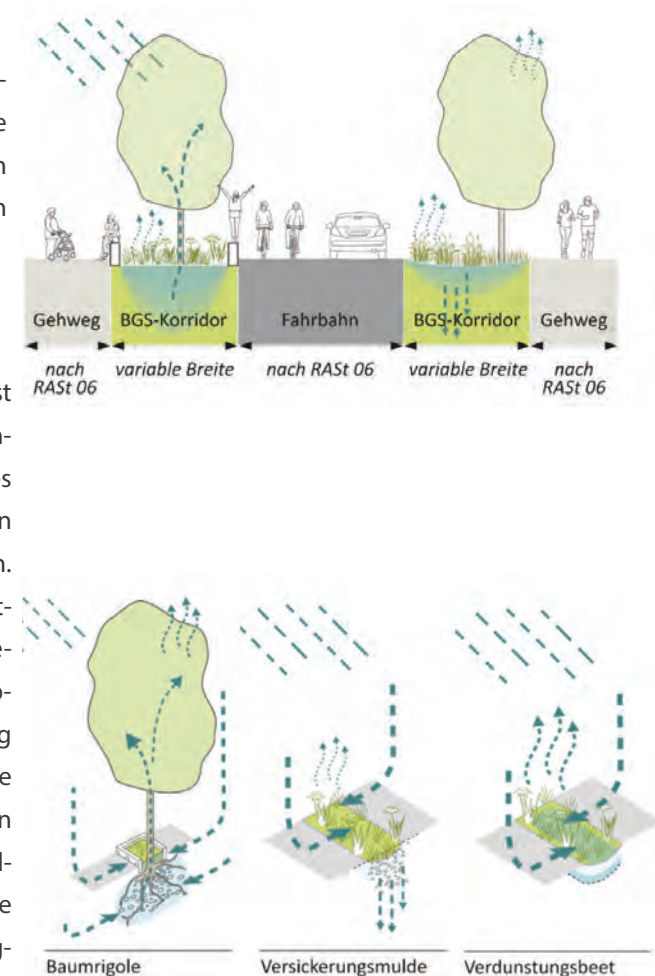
Multicodierter Straßenraum, bgmr Landschaftsarchitekten GmbH
